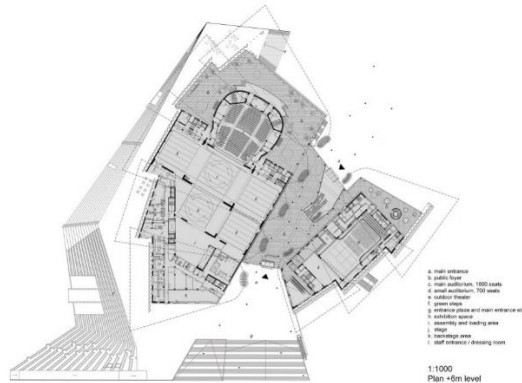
Vista de planta del teatro del Wuxi Grand Theatre.
